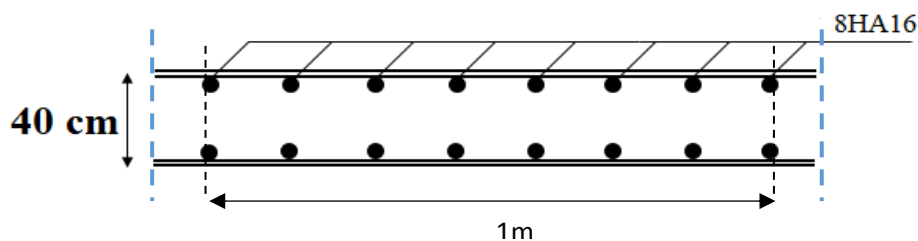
Ferrailage de la dalle du radier sens y-y.
